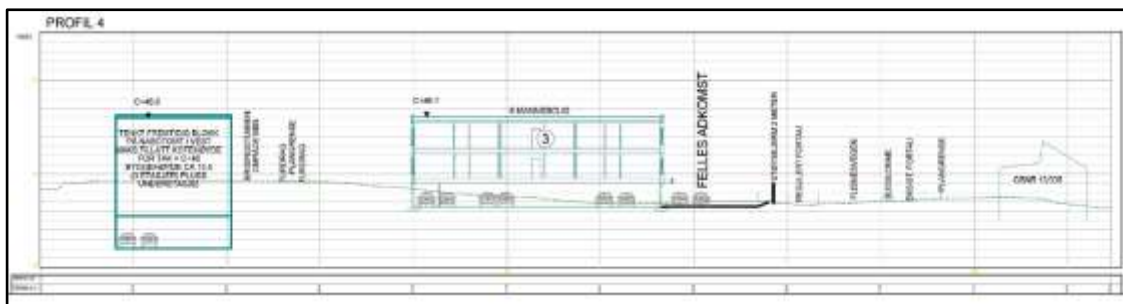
Terrengprofilene viser hvordan høydesetting er planlagt innenfor området, her illustrert med flatt tak. Profil 1 viser bebyggelsen i vestlig del av illustrasjonsplanen. Illustrasjonene er ikke bindende for gjennomføring av planen. Profilene er vedlagt planforslaget.
